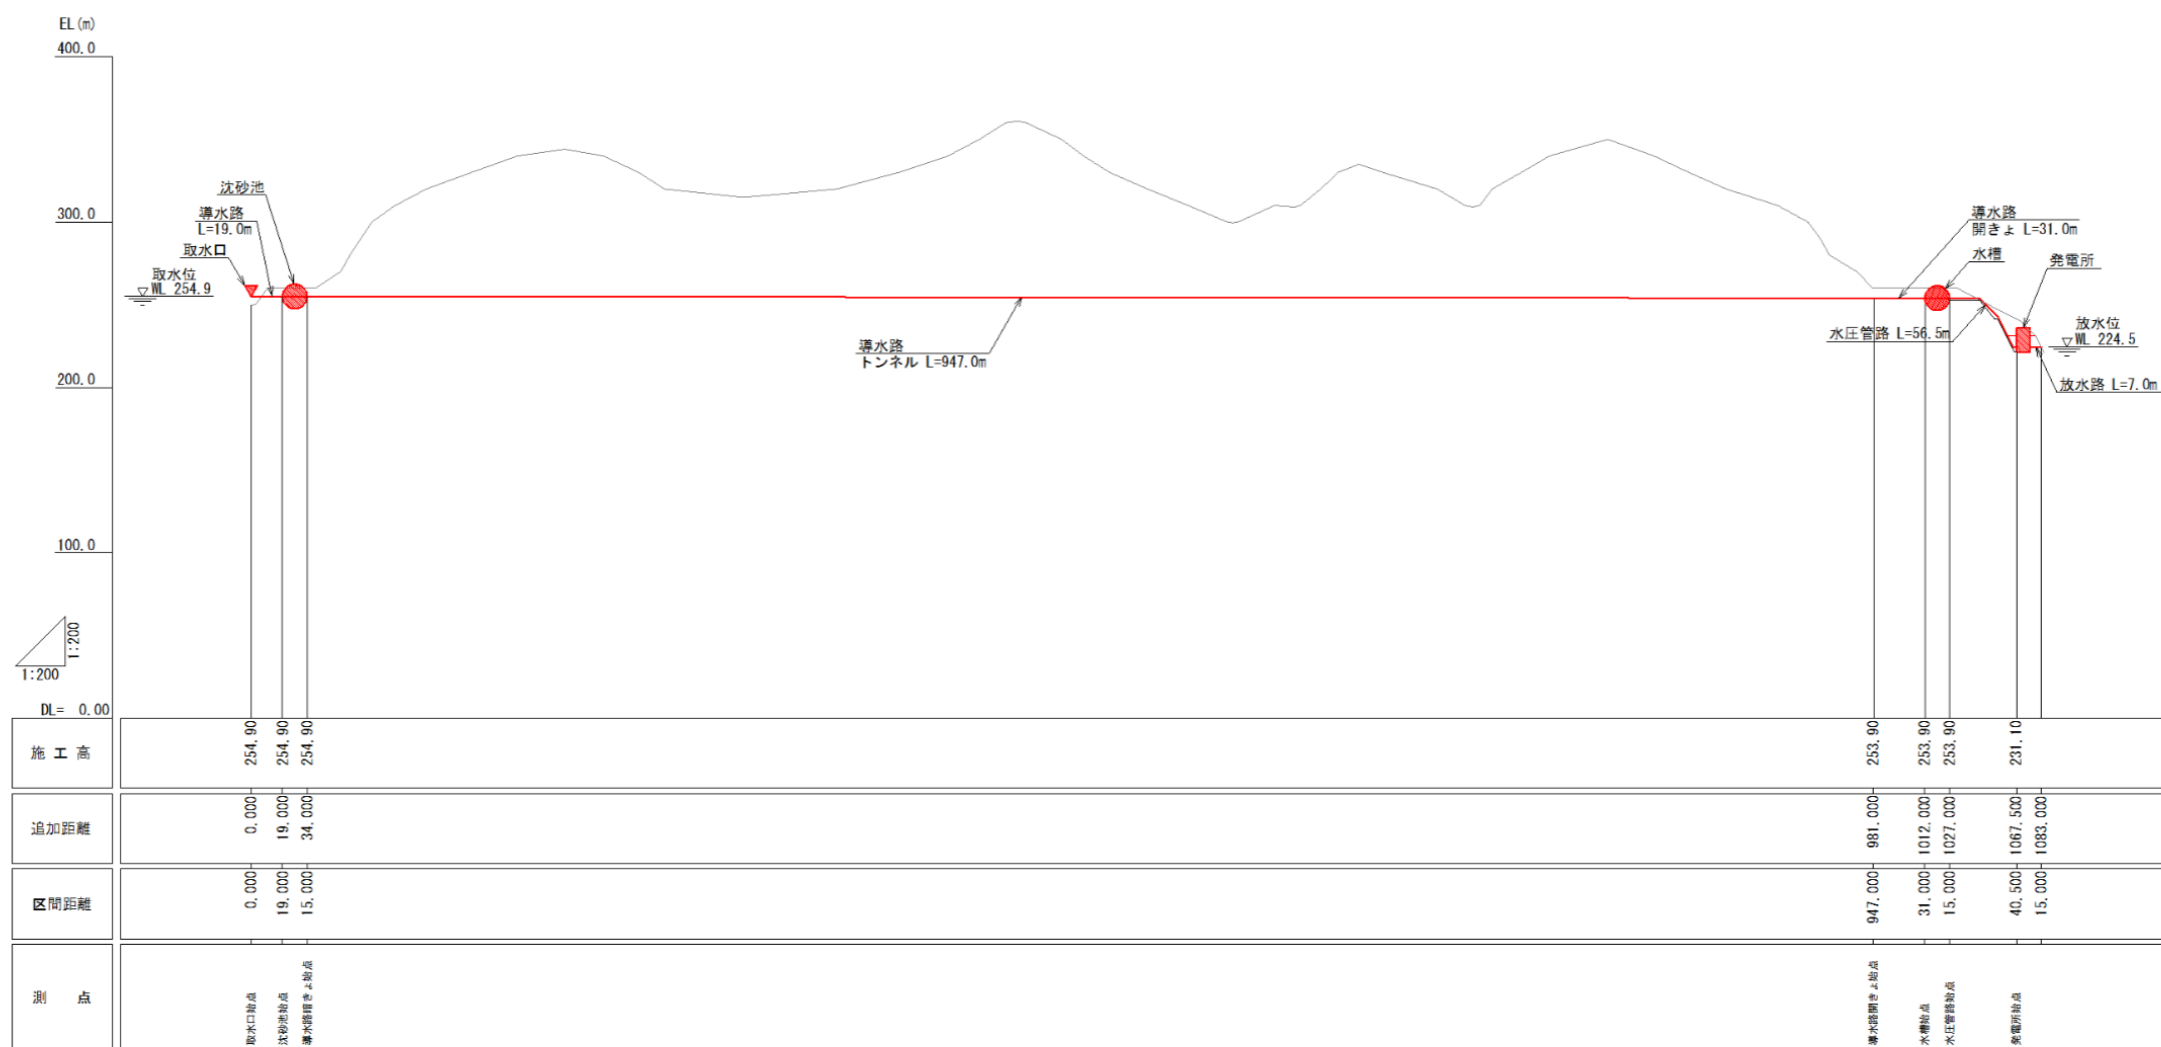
水路縦断面図 (頓定地点) NO-SCALE
